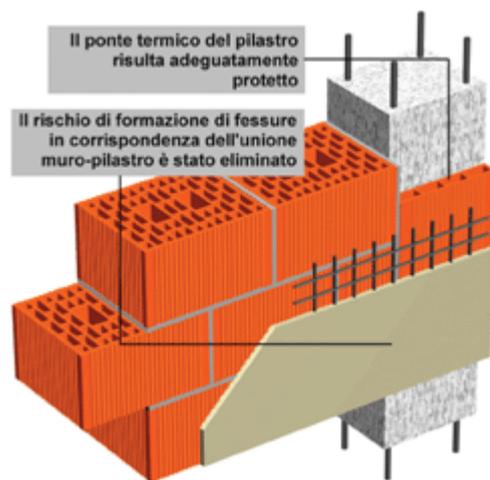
Corretta esecuzione della giunzione tra muratura di tamponamento e struttura in c.a.
